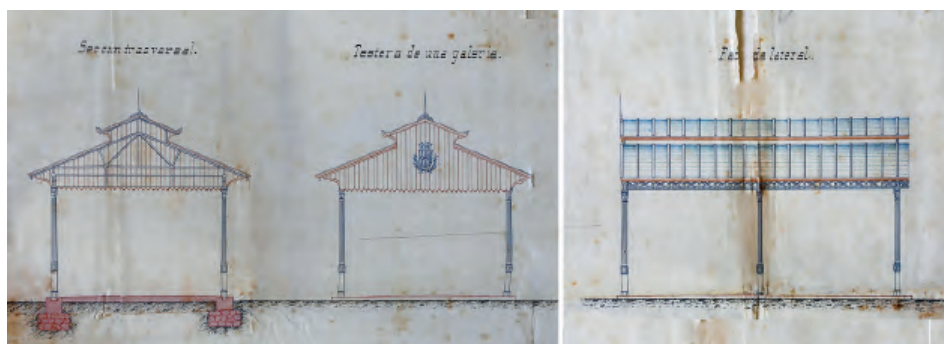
Antonio Martorell y Trilles, Proyecto de mercado de Alzira, 1882. Sección transversal, fachada y alzado lateral de una galería. Arxiu Municipal d'Alzira.
